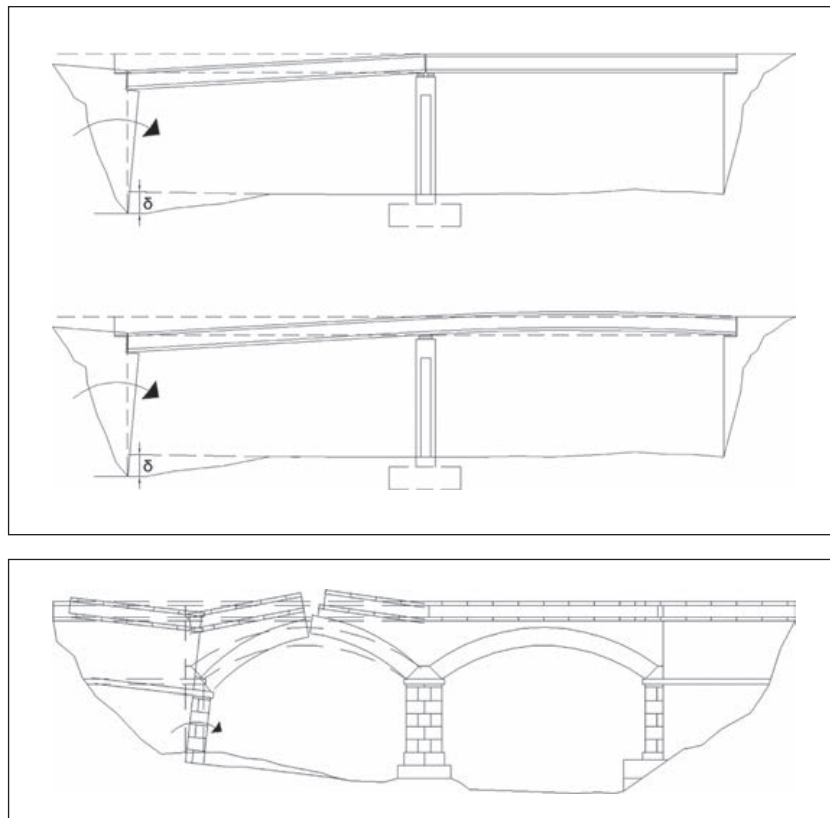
EFECTOS DEL DESCENSO DE ESTRIBO EN ESTRUCTURA ISOSTÁTICA E HIPERESTÁTICA.
